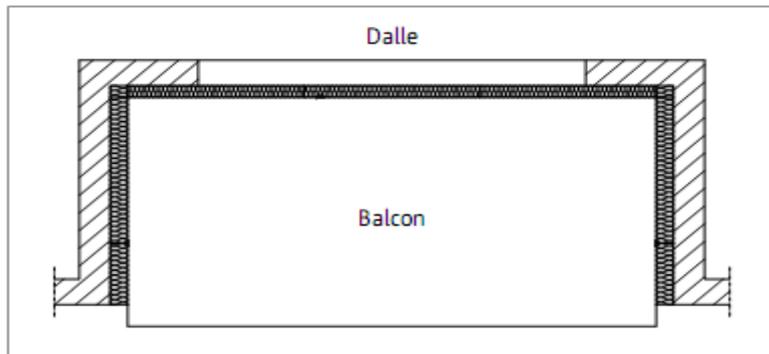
Balcon en béton armé appuyé sur trois côtés.
